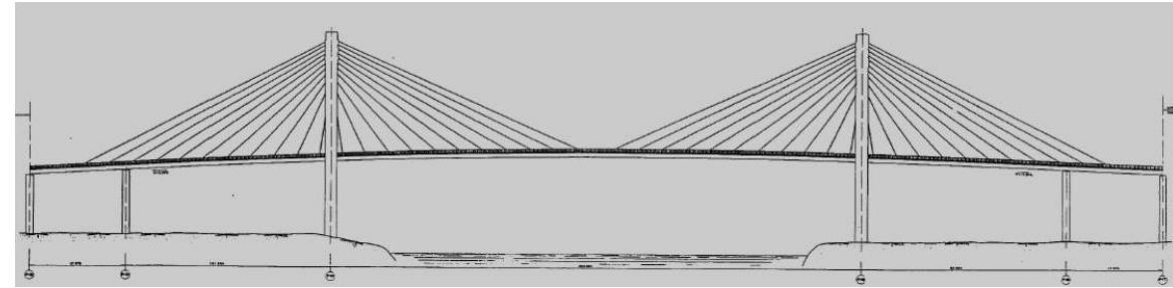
Alzado del tramo atirantado del Viaducto del Centenario
